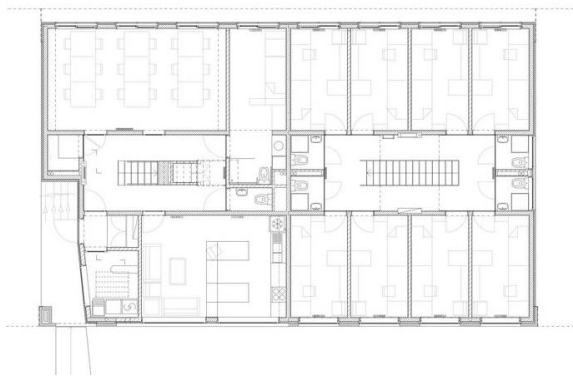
Planta tipo de diseño de habitaciones, FUENTE: Arch Daily.
